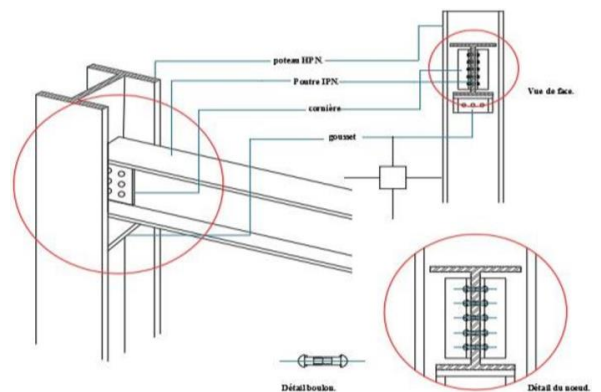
Détail n°03: assemblage boulonné d'une poutre à l'âme d'un poteau
